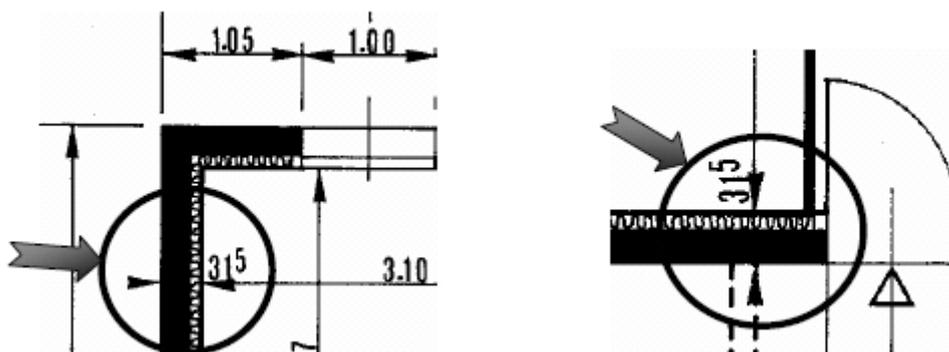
EXTRAITS DU PLAN DU REZ-DE-CHAUSSEE (Figure 8)
